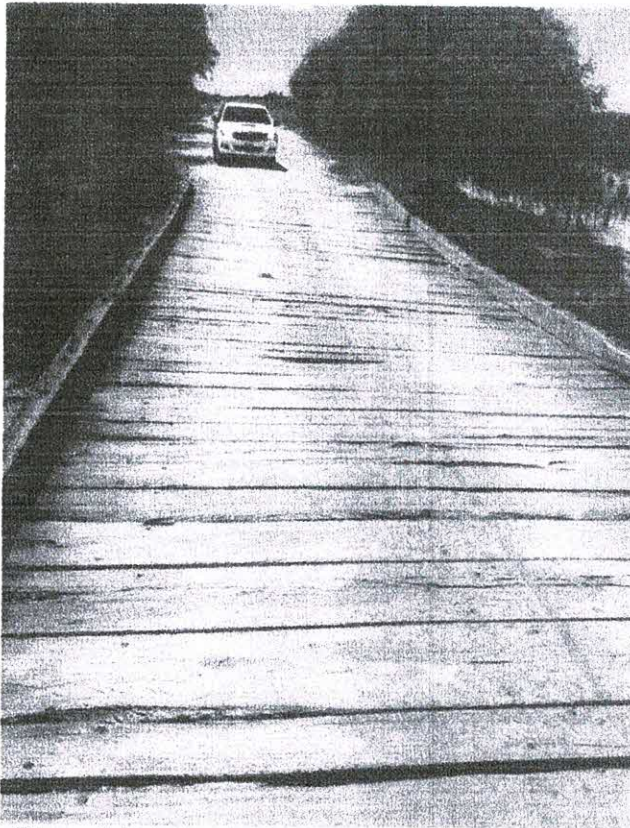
Estado actual estructuras sobre Arroyo El Rey
